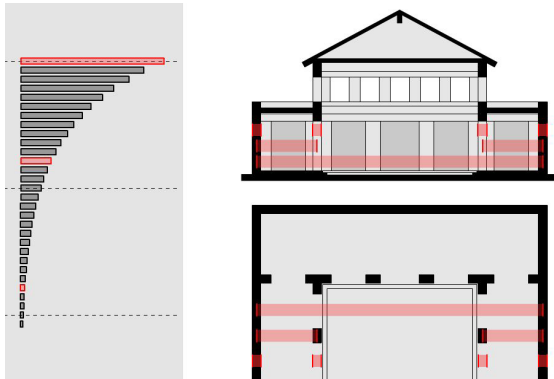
Planta e corte transversal pela nave da igreja, demonstrando o sistema de medidas do Número Plástico
